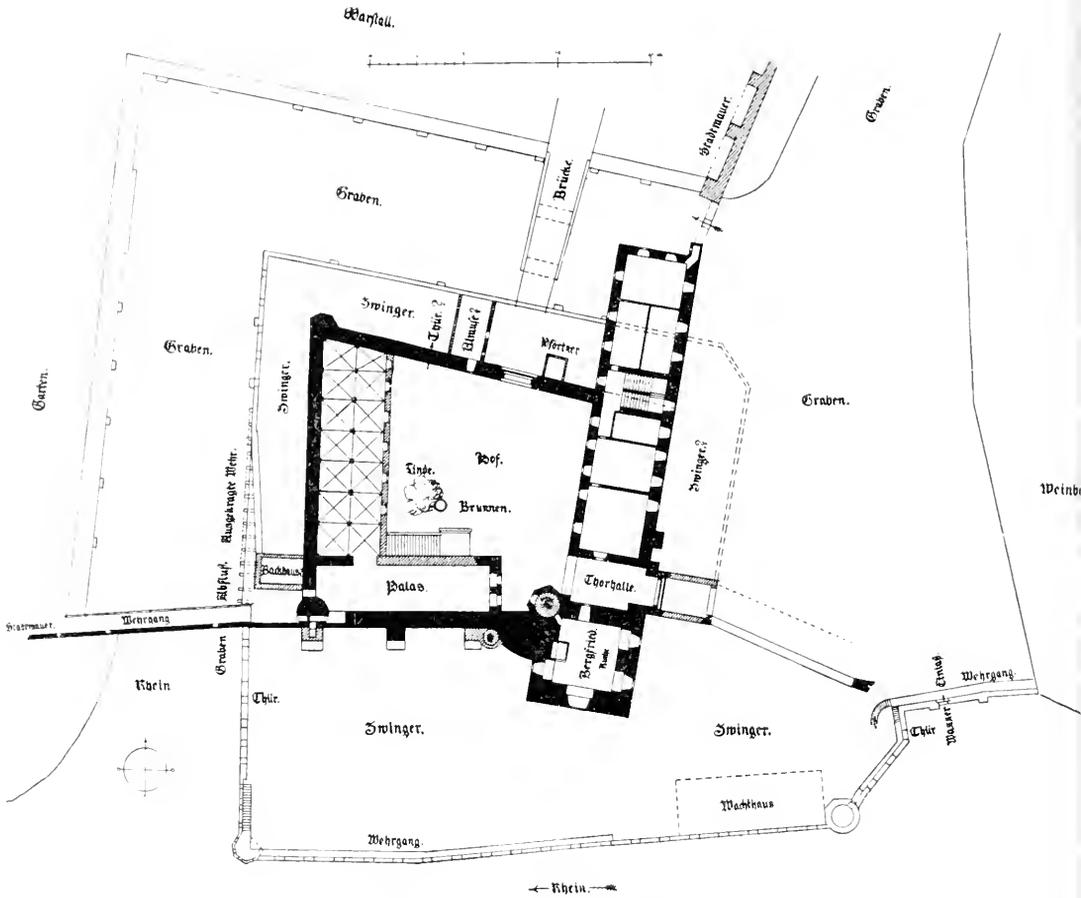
Grundriss der Burg (Erdgeschoss).
